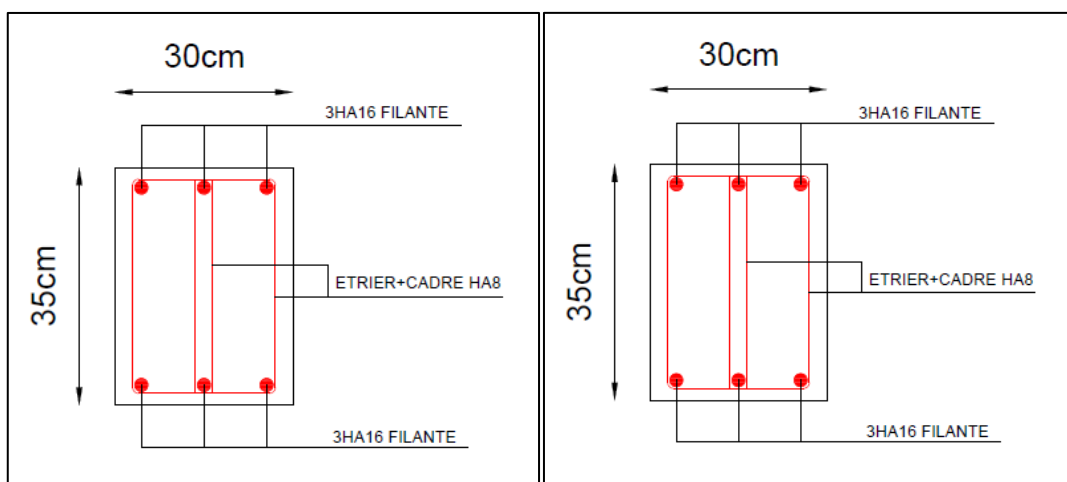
Schéma de ferrailage des poutres secondaires (35×30) cm selon le calcul à L’E.L.U sur travée.
